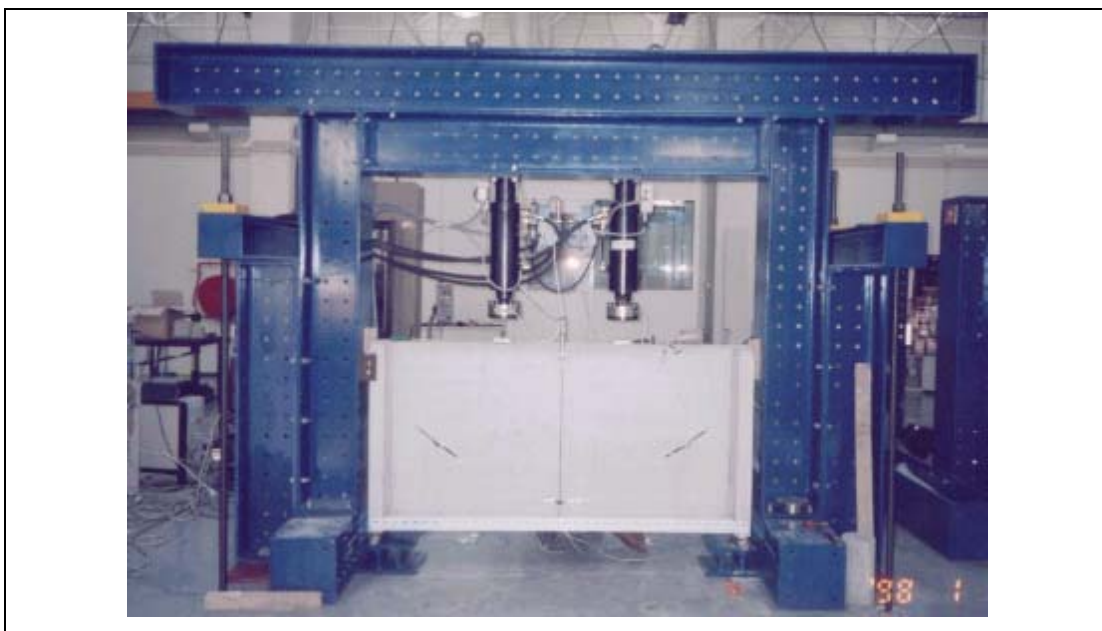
Viga-parede instrumentada externamente com “clip gages” e LVDTs
